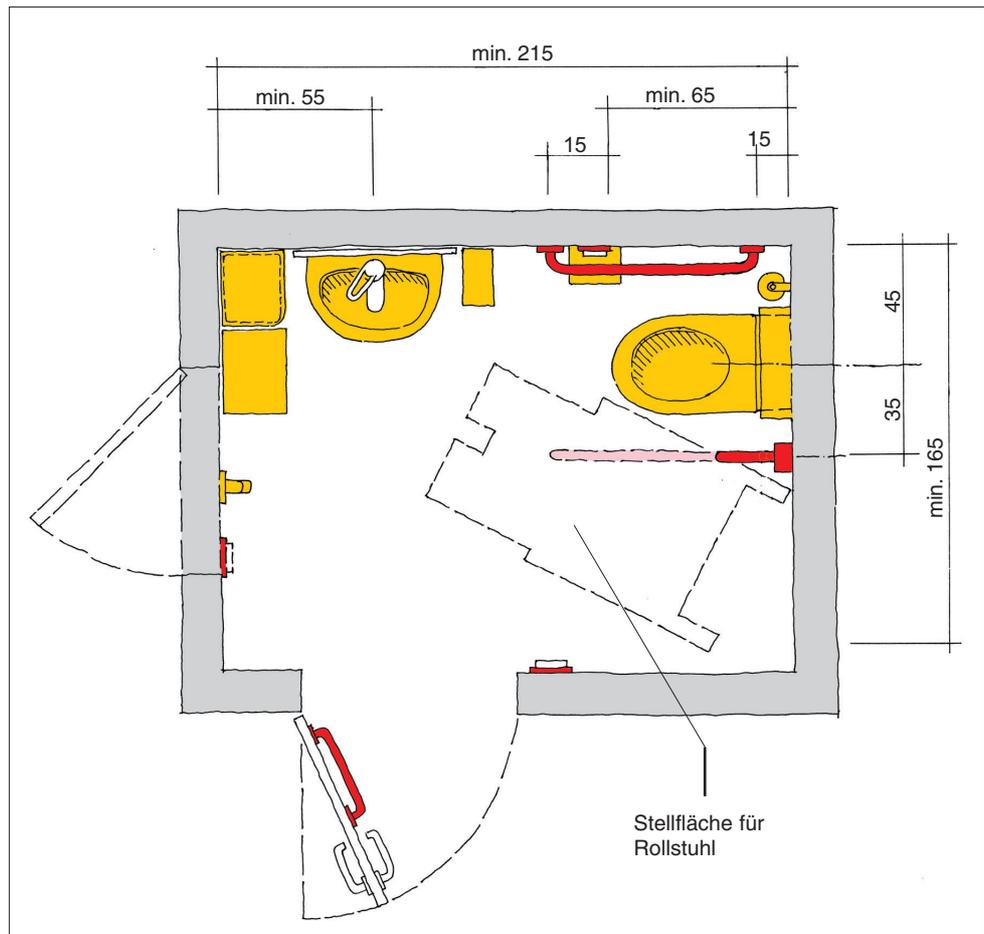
Grundriss zu Bild 1 (Mindestgröße nach ONÖRM B 1600)
